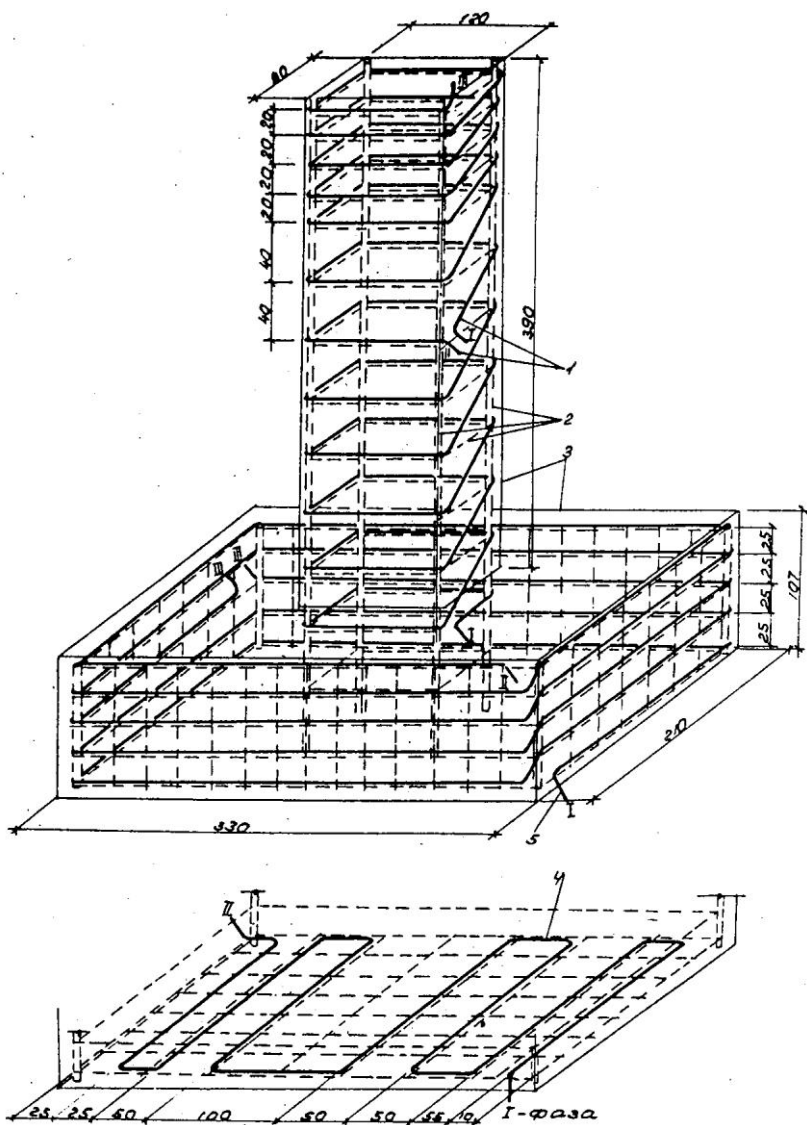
Схема установки нагревательного провода в столбчатом фундаменте: 1 – нагревательный провод; 2 – арматурный каркас; 3 – контур конструкции; 4 – нагревательный провод по основанию; 5 – выводы провода для подключения к источнику питания
